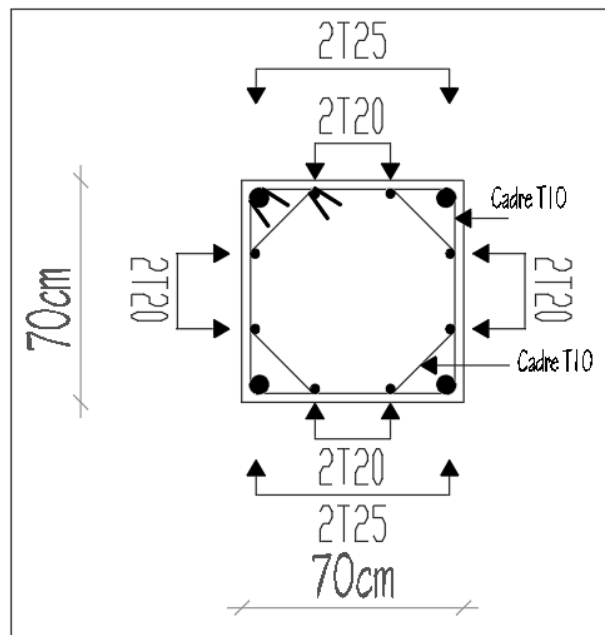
le schéma de ferraillage des poteaux 70*70
